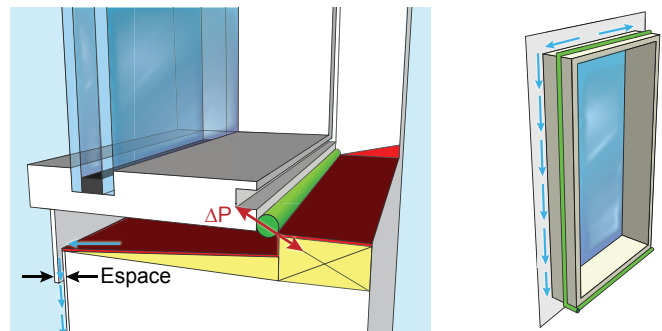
Détails d'un appui de fenêtre montrant l'espace laissé à l'arrière de la bride et le plan d'étanchéité à l'air situé derrière l'appui. L'espace entre la bride et le joint d'étanchéité permet à l'eau qui entre derrière la bride de s'infiltrer jusqu'à la base de la fenêtre et de s'exfiltrer de l'assemblage par l'appui.
